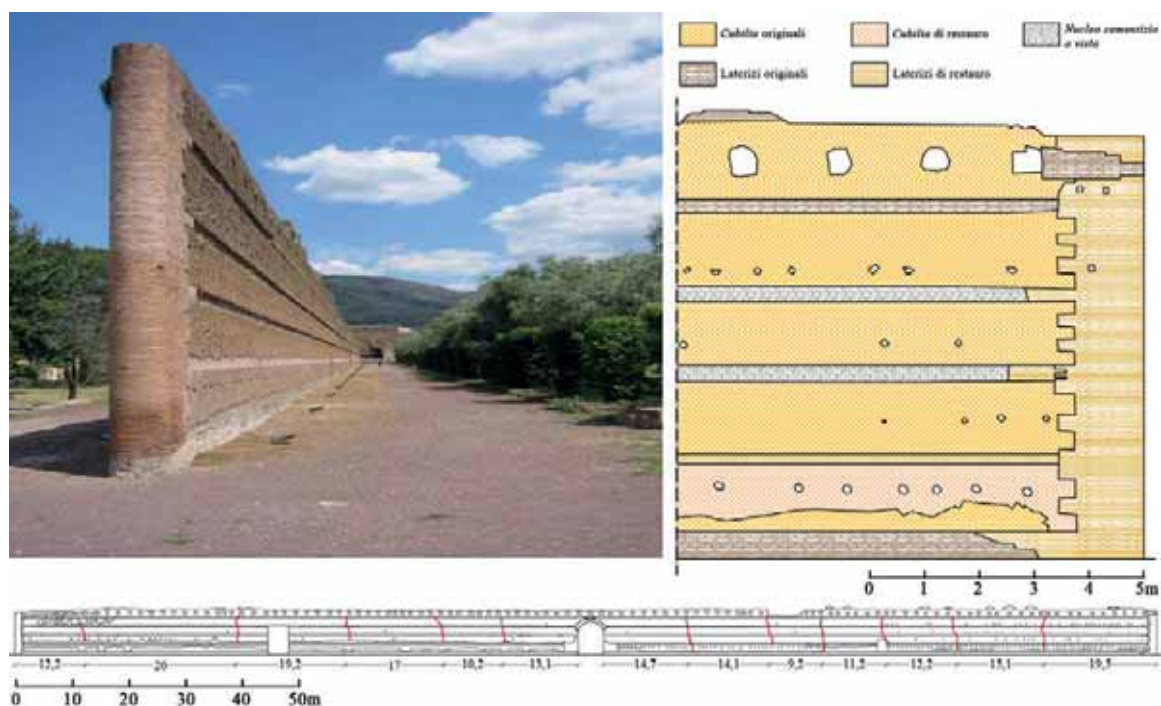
Villa Adriana, muro di spina del Pecile: (in alto a sinistra) vista del prospetto sud; (in alto a destra) dettaglio del rilievo del prospetto nord con caratterizzazione delle tecniche esecutive; (in basso) rilievo del prospetto nord con evidenziati le tracce delle riprese di getto. (Rilievo RiVA, resp. Cinque G.E., 2011)
